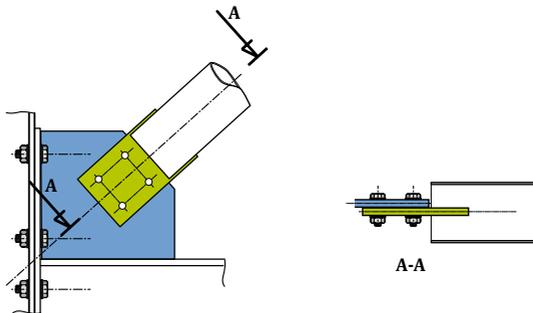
Assemblage par gousset enfourché pour une diagonale à section circulaire creuse
